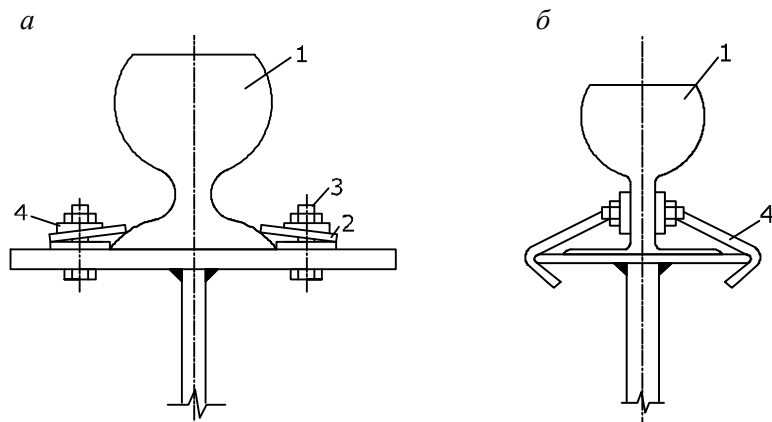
Схемы крепления подкрановых рельсов к стальным балкам:
